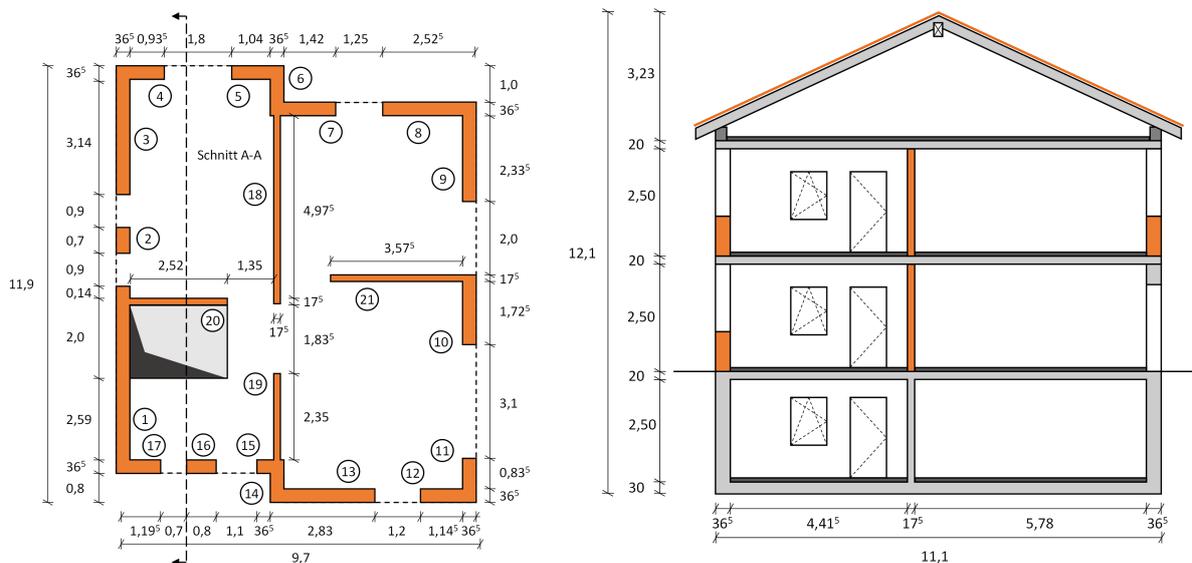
Grundriss (links) und Ansicht (rechts) des betrachteten Einfamilienhauses
